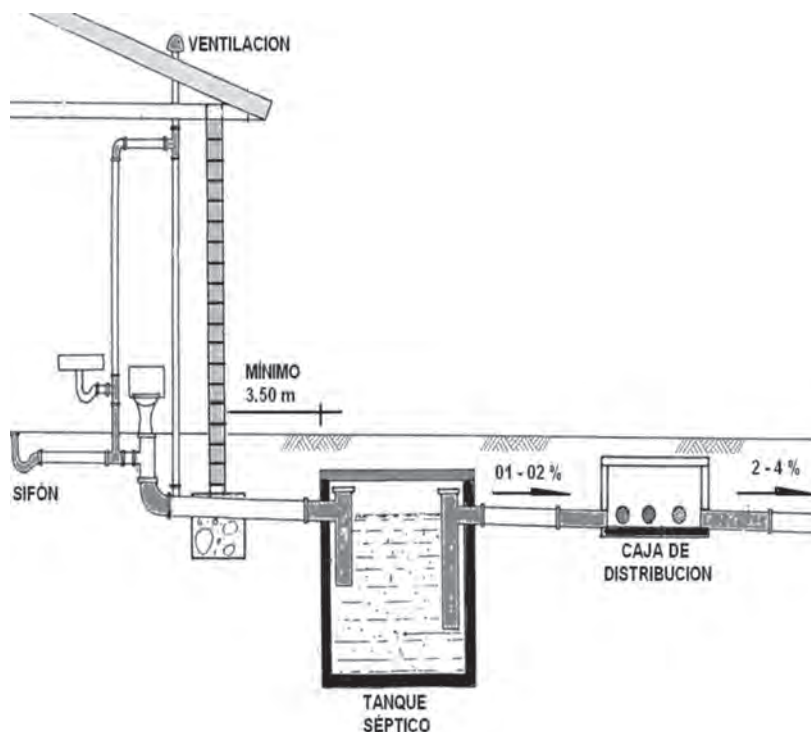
Esquema para la instalación de un pozo séptico destinado al tratamiento de las aguas residuales provenientes de una vivienda rural.
